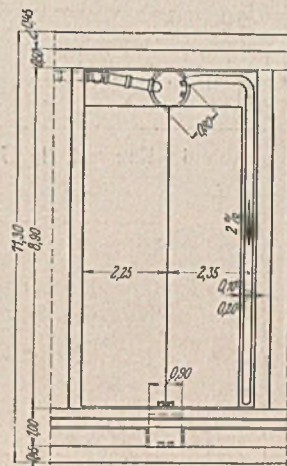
Bauwerk I, Grundriß der Pfeilerkammer.
